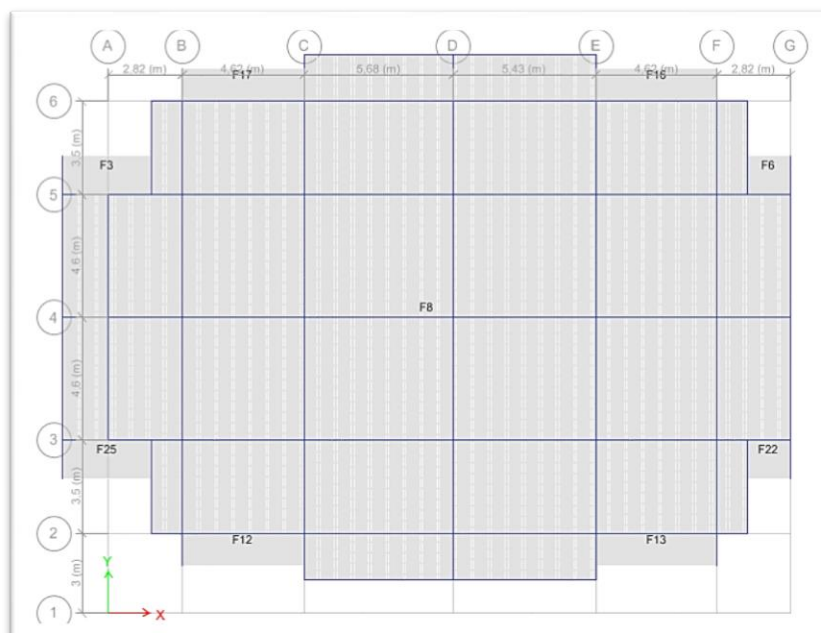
Disposition des poutrelles.II.1.2 Dimensionnement des planchers :
